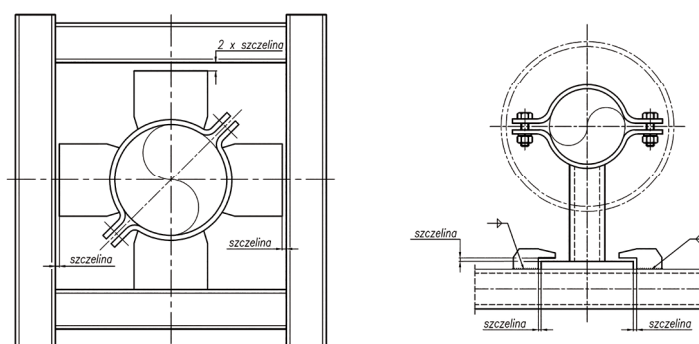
Przykład podparcia ślizgowego przytwierdzonego do stropu żelbetonowego
